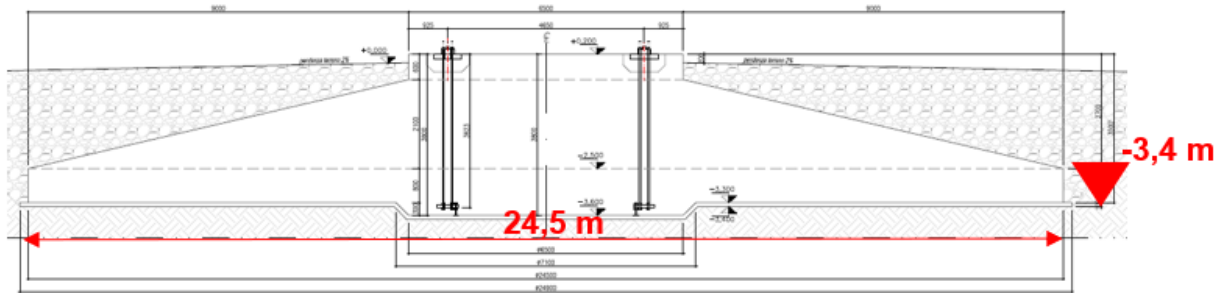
Fondazione diretta tipologica circolare ϕ 24,50 m per aerogeneratore HH=125 m R=162 m
